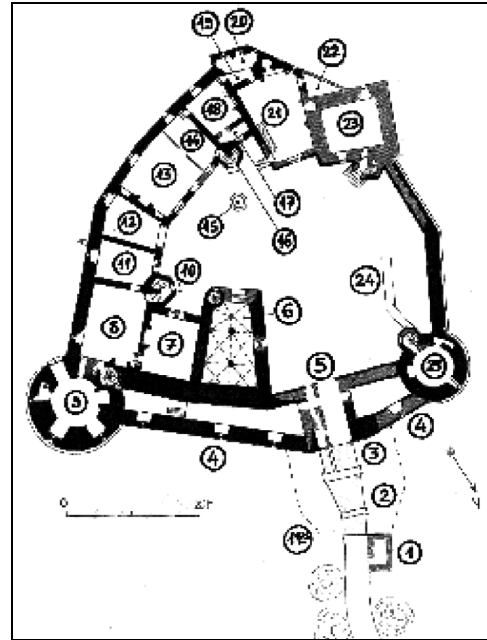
Restitution du plan du château à la fin du XVIII^e siècle. Cette restitution repose principalement sur un plan de Charles Suisse montrant l'avancement du chantier en juillet 1900. Les parties en gris clair montrent d'ailleurs les murs qui ne subsistaient plus alors qu'à l'état de fondation. La distribution intérieure du château à la toute fin du XVIII^e siècle est accessible par les visites faites en 1746 et 1767, et surtout par les inventaires de 1759, 1771, 1794 et 1798. Certains éléments de détail sont cependant purement hypothétiques, mais liés à des mentions textuelles (four et escalier de la cuisine ; cloisons)
